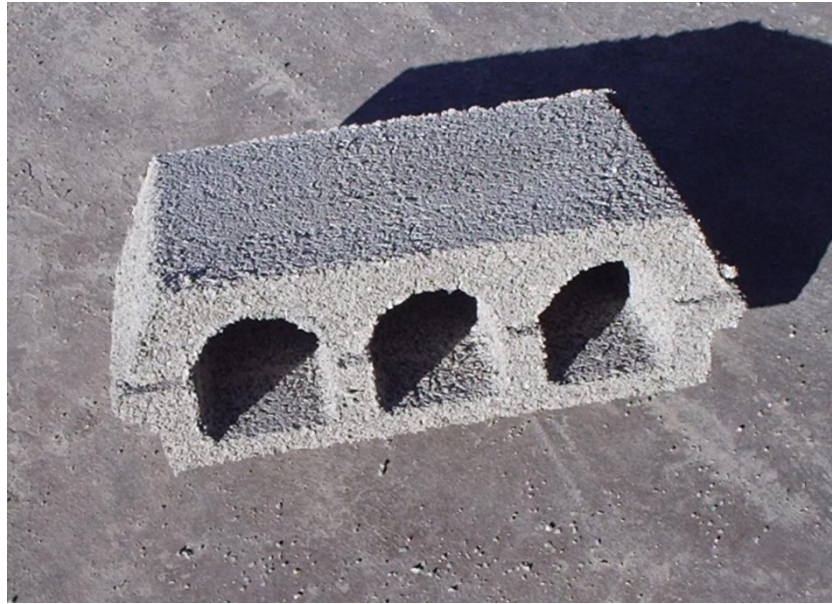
Bloque para losa elaborado con PET reciclado. Fuente: archivo fotográfico de CEVE.
